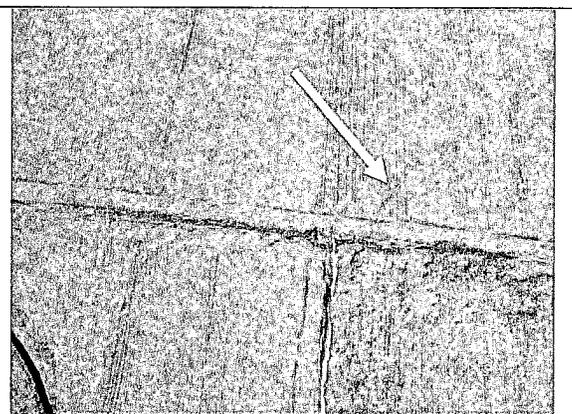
FISURA EN LOSA DE PAVIMENTO
